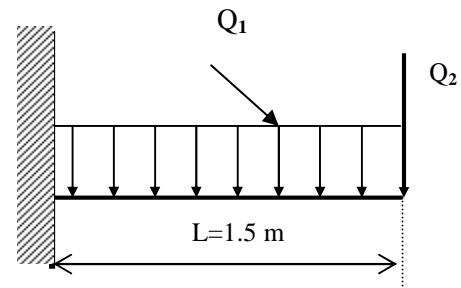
Schéma statique de calcul de la dalle pleine
